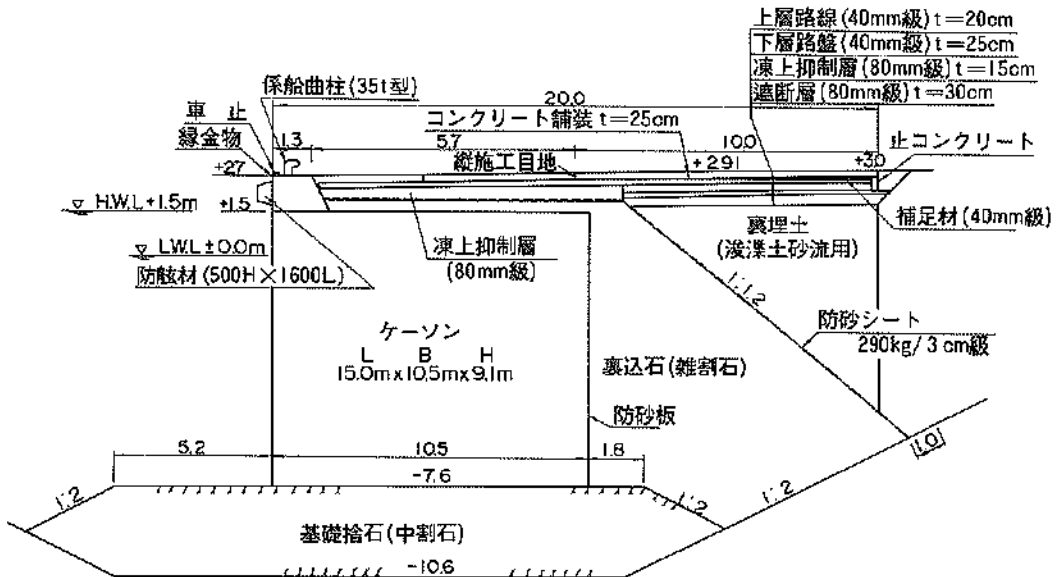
標準断面図 (浦河港, 岸壁(-7.5m))
